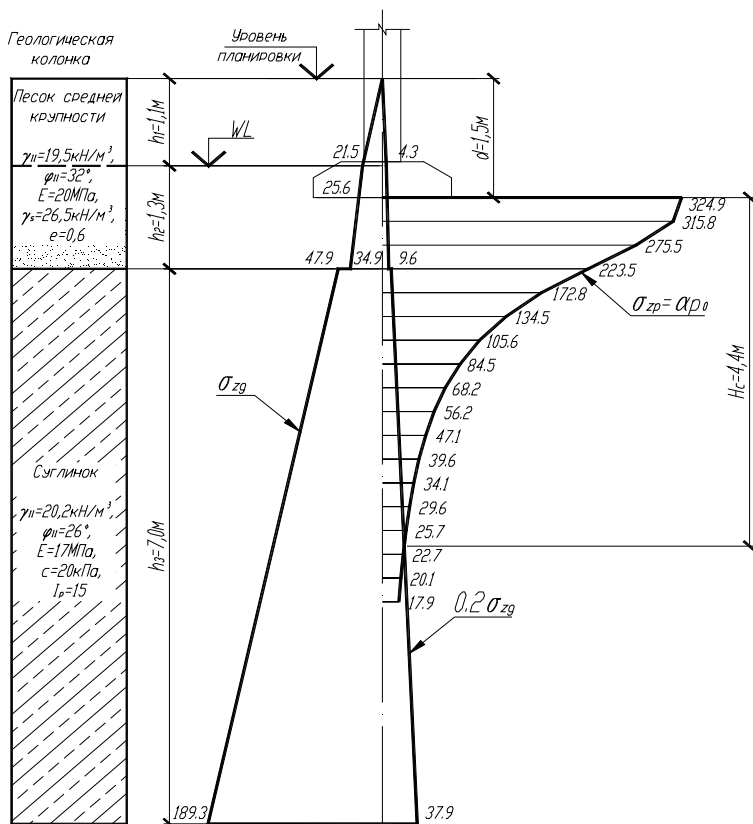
Расчетная схема для определения осадки фундамента мелкого заложения методом послойного суммирования
